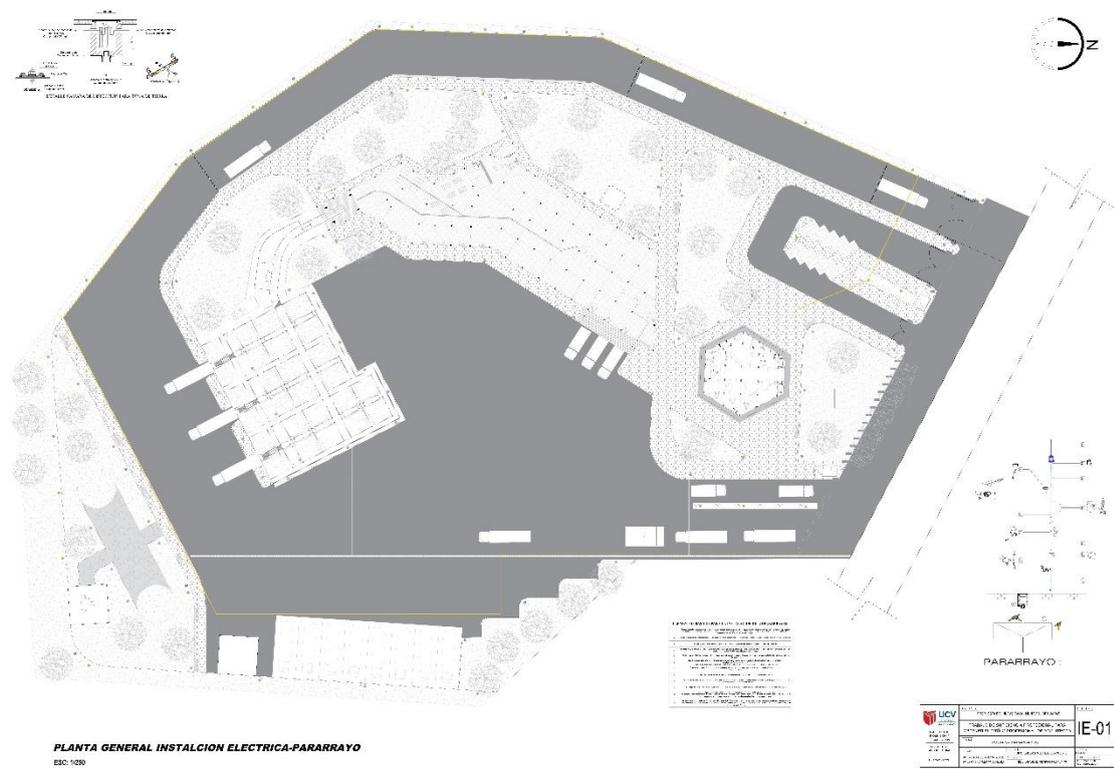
Plano General de Instalaciones Eléctricas exteriores(pararrayos)
